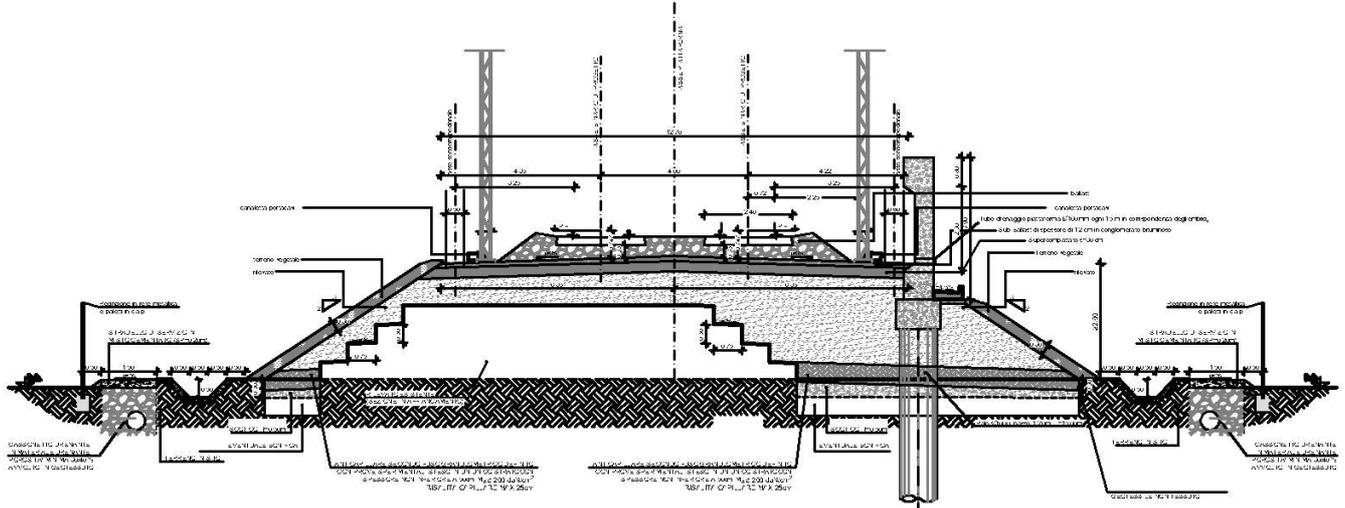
sezione tipo rilevato con muro di recinzione in affiancamento in assenza di esercizio
